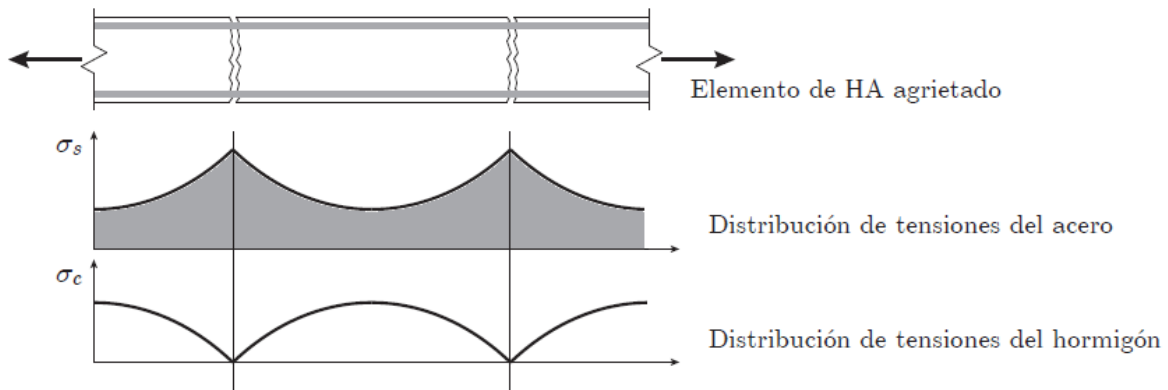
Distribución de tensiones en una sección de hormigón armado.
